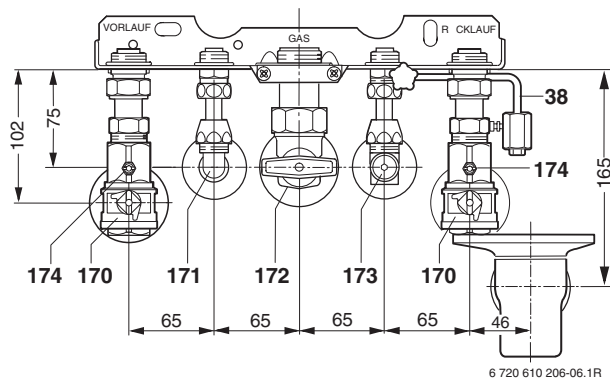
Монтажная плата для монтажа трубопроводов под штукатуркой (смонтирована)
